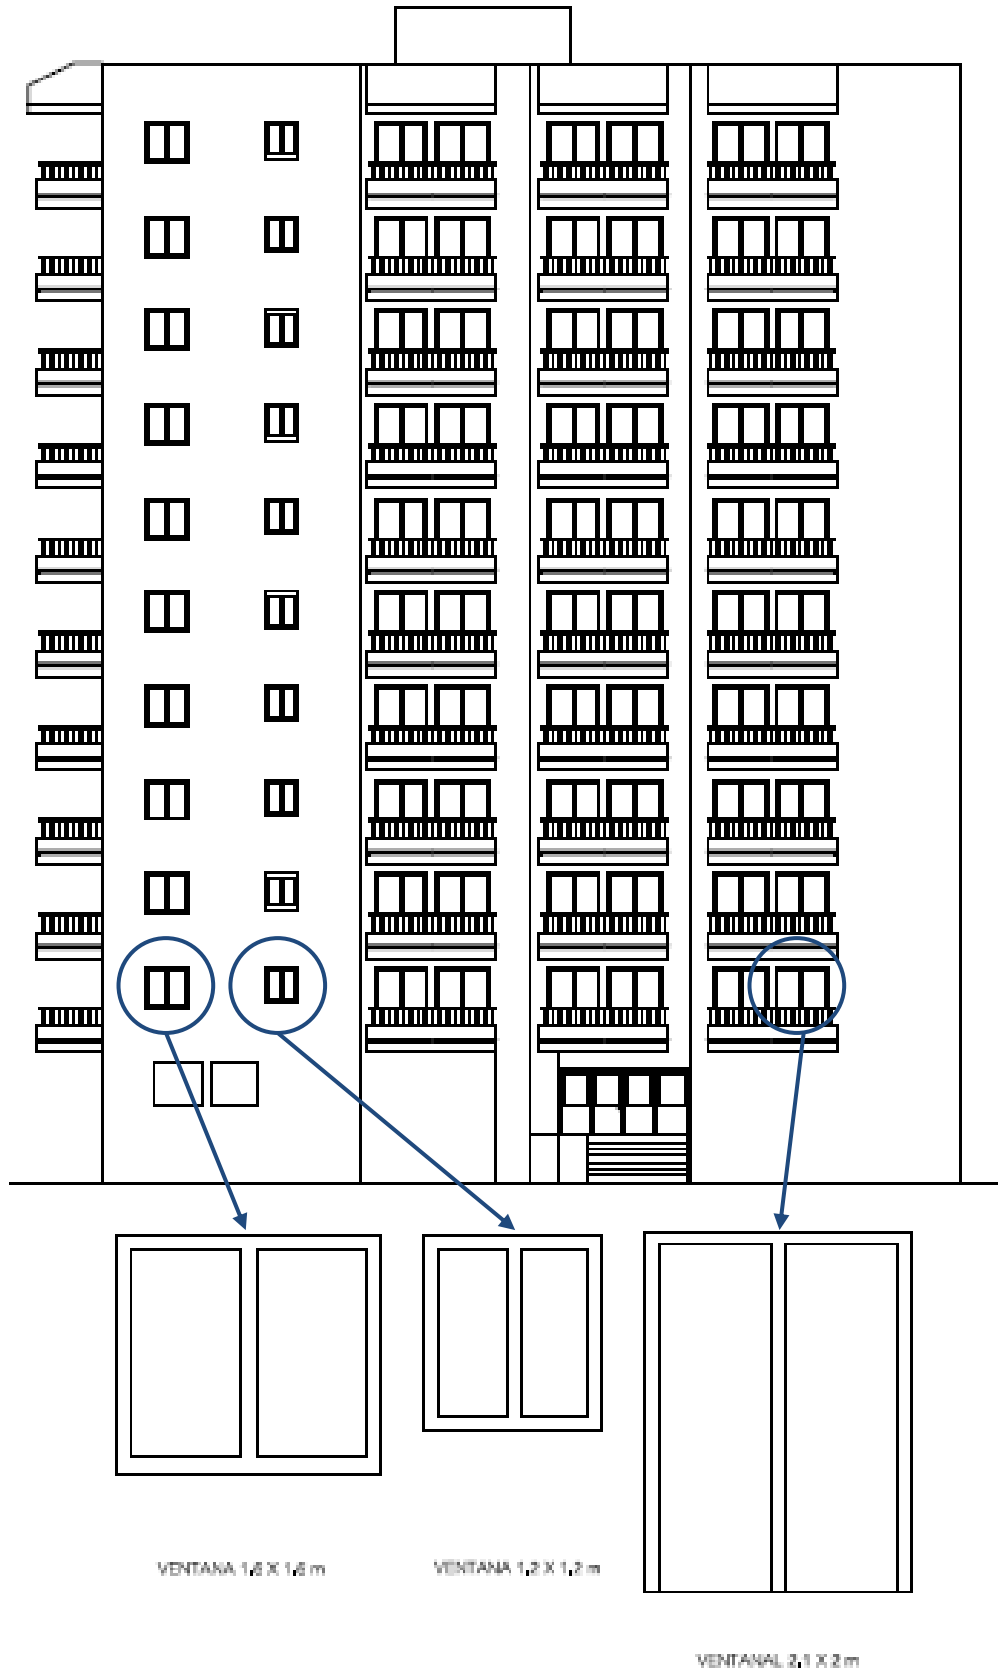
Detalles y perspectivas de la carpintería de aluminio con rotura de puente térmico.
